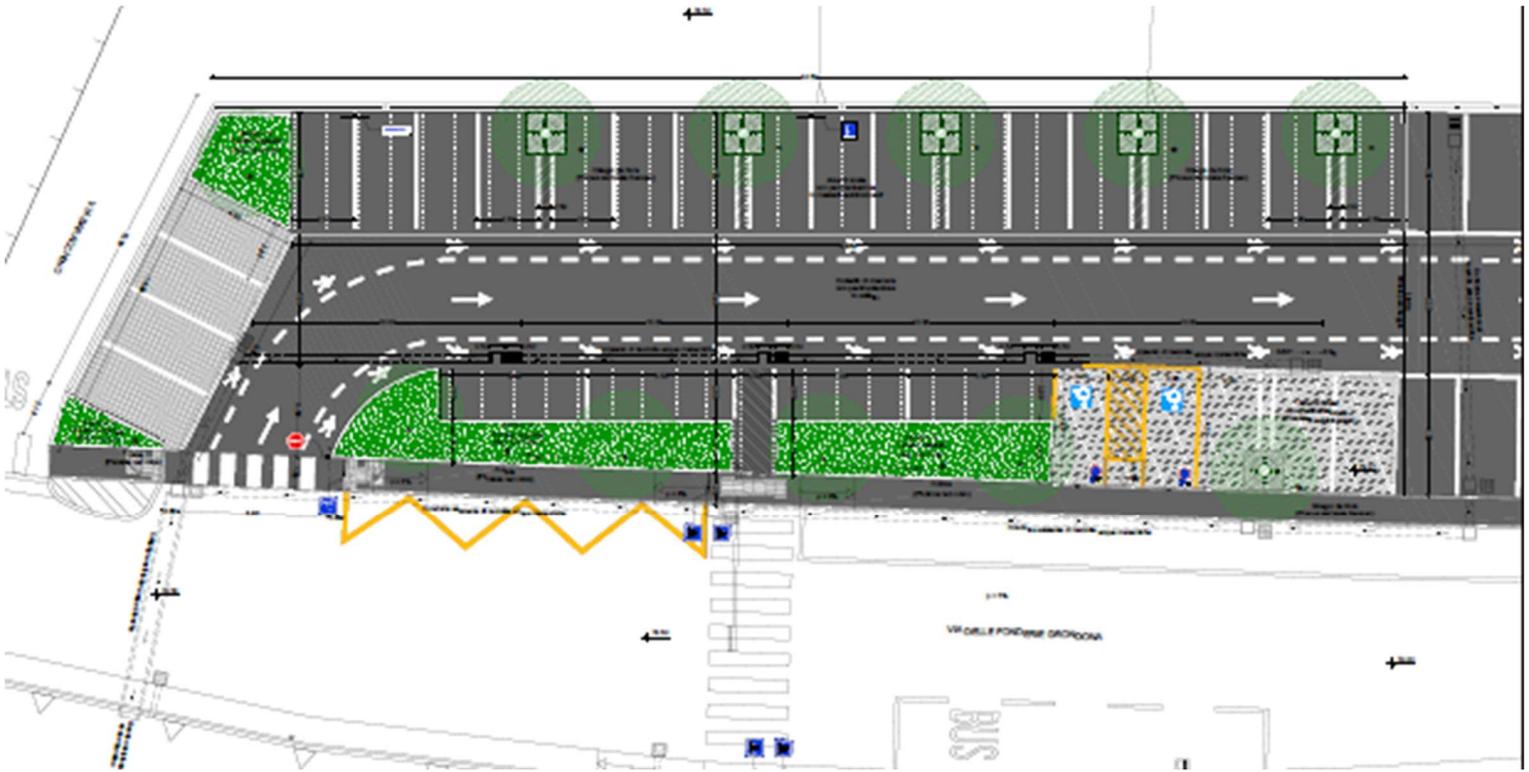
Progetto Planimetria di dettaglio (Tav. E.AR.13)
